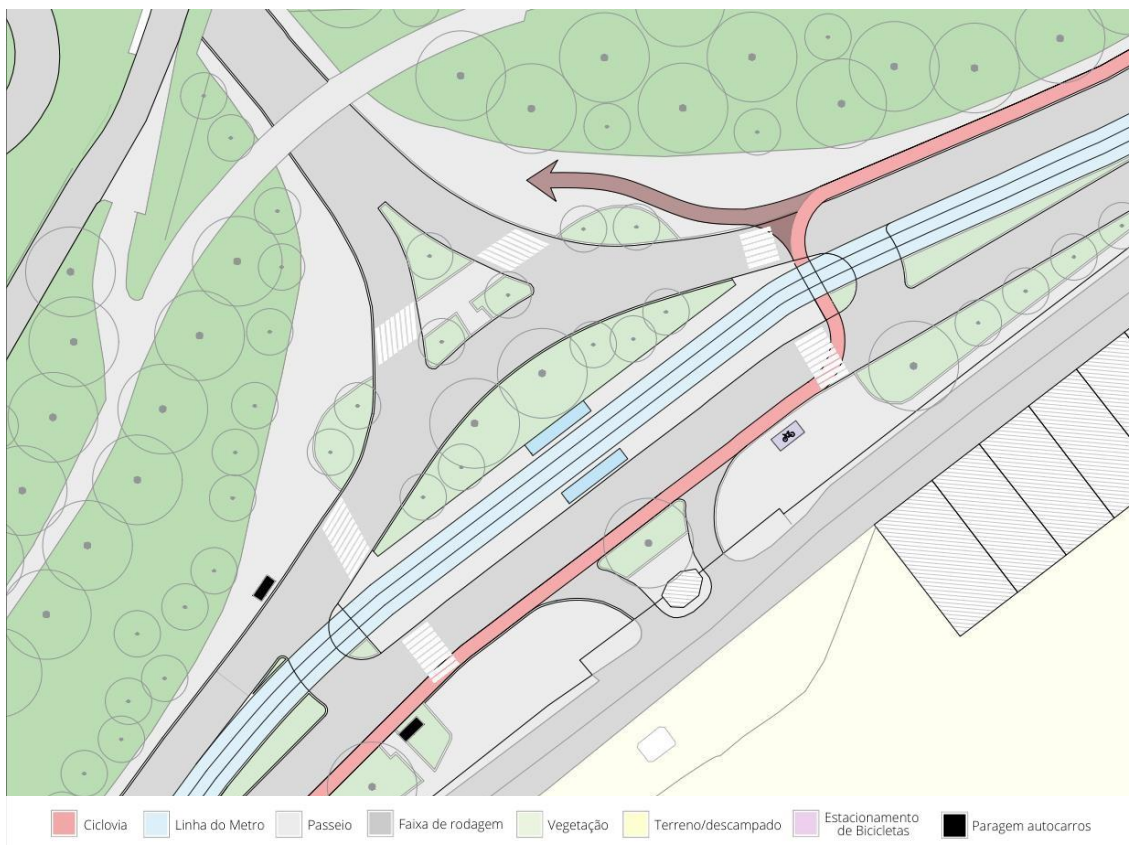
Planta 04 - Avenida Antunes Guimarães
